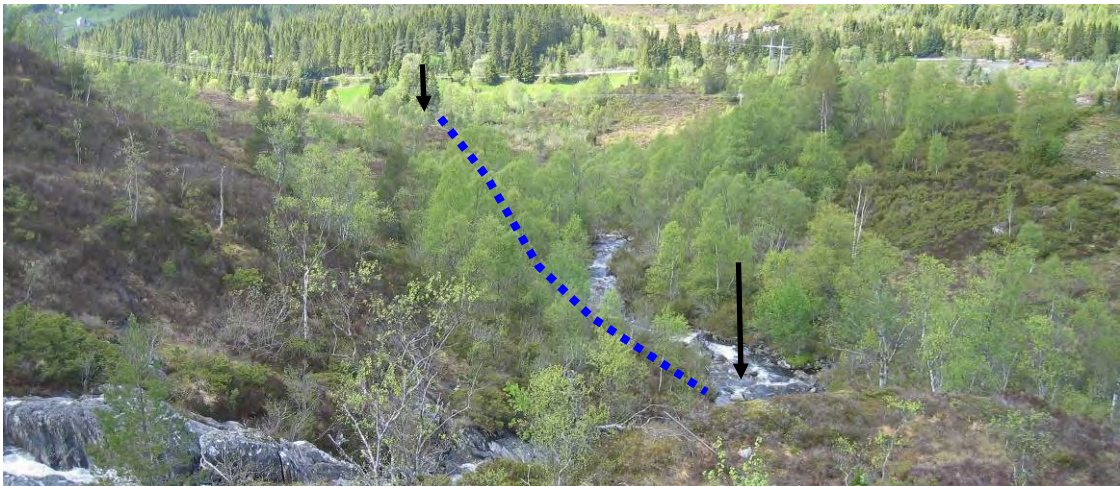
Utløpet av Navevatnet. En lav betongterskel er planlagt etablert om lag langs den stiplede linjen. Videre etableres arrangement for slipping av minstevannføring samt arrangement som gir passeringsmulighet for fisk.
